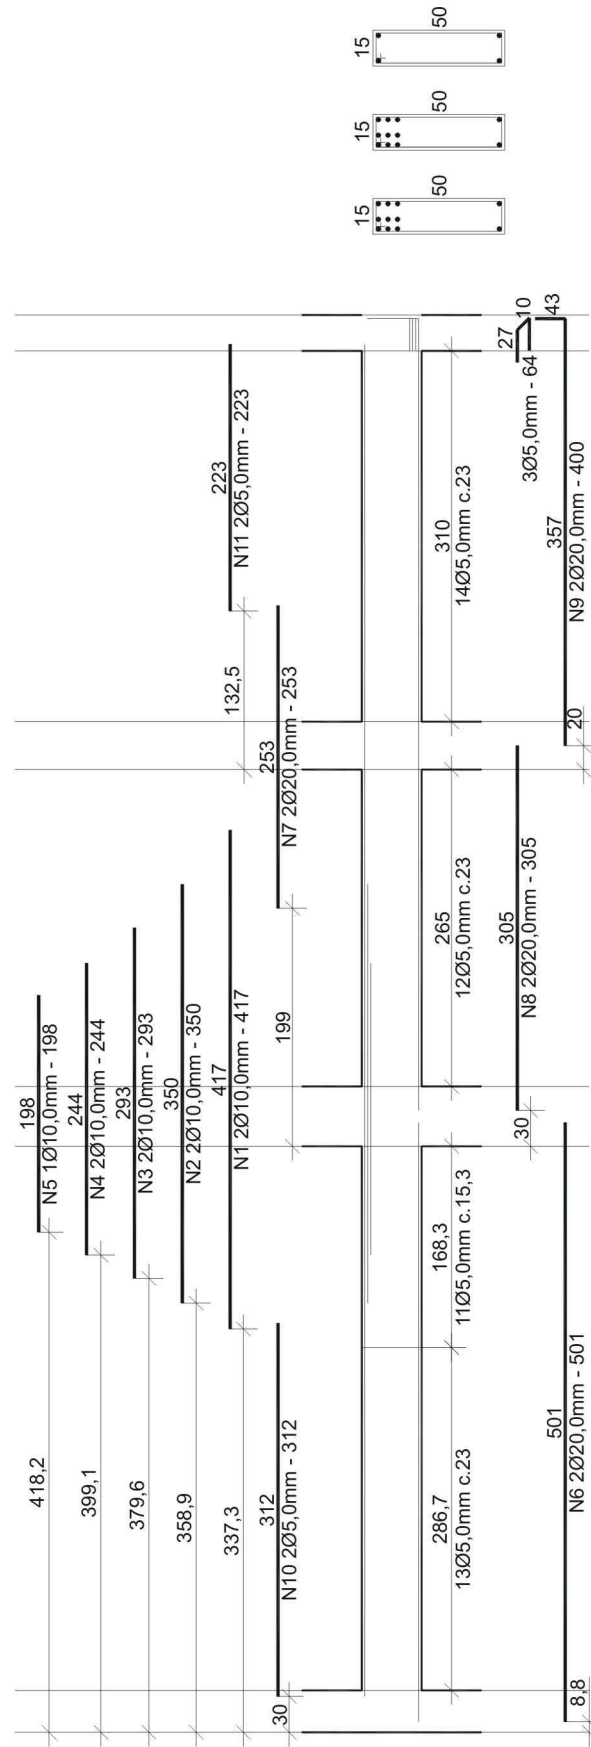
Detalhamento Viga 04.2, realizado pelo VigaCalc.
